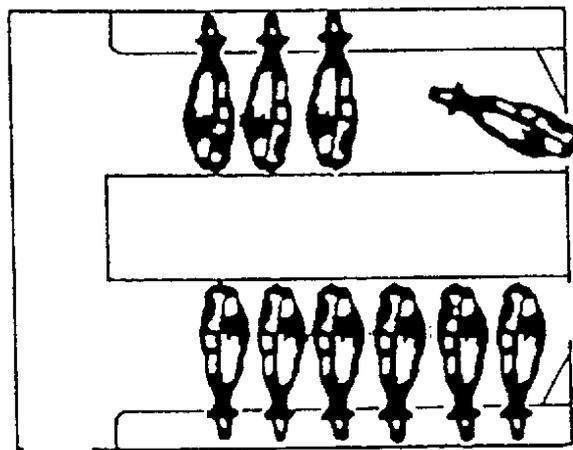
Grundriss eines Tandemmelkstandes
